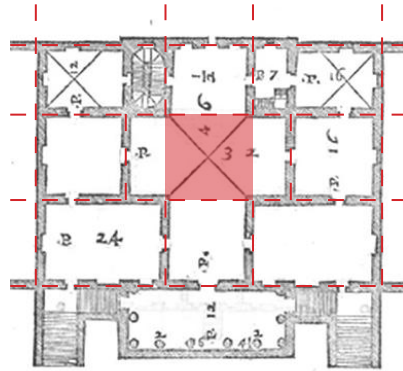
Andrea PALLADIO - Plan de la villa Malcontenta - 1560
